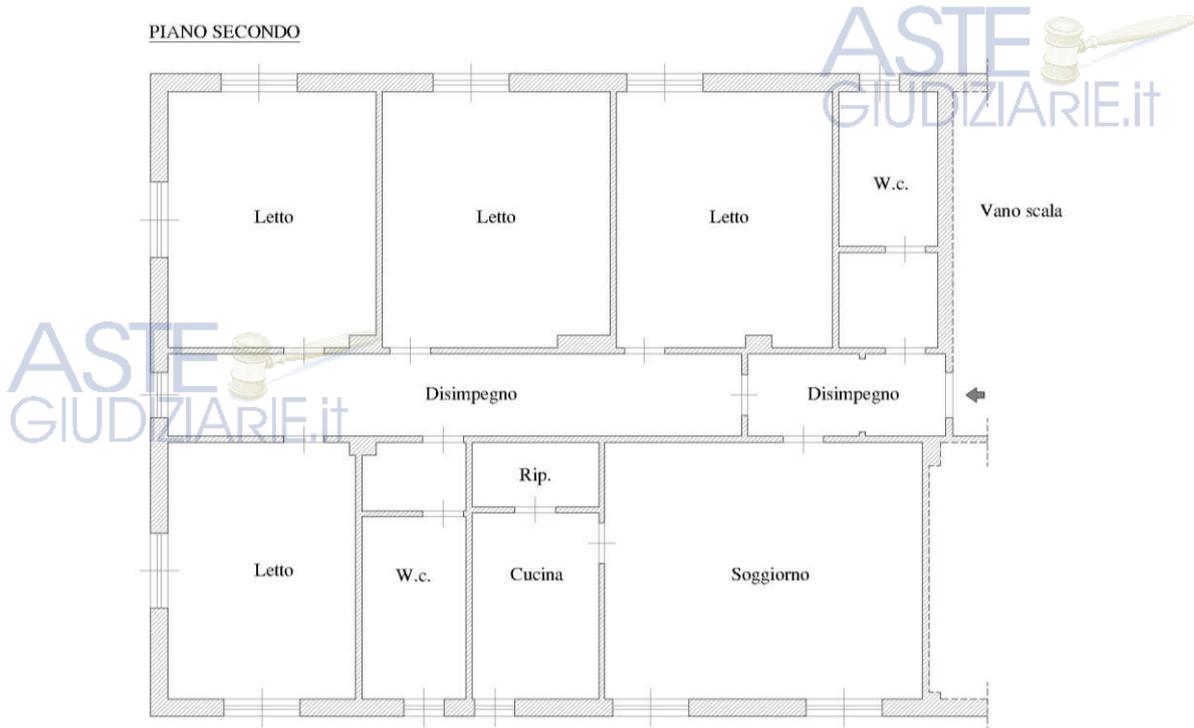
Planimetria Abitazione (n.1) piano secondo
